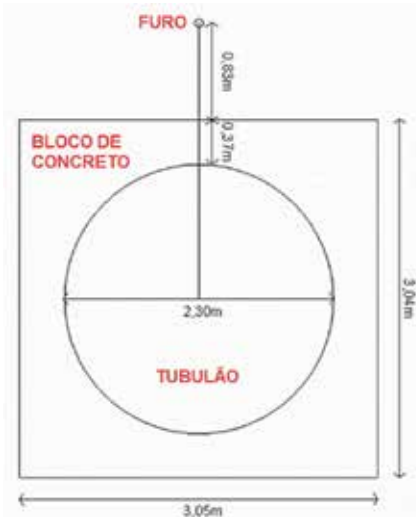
Croqui da fundação e a posição do furo utilizado no ensaio PS
